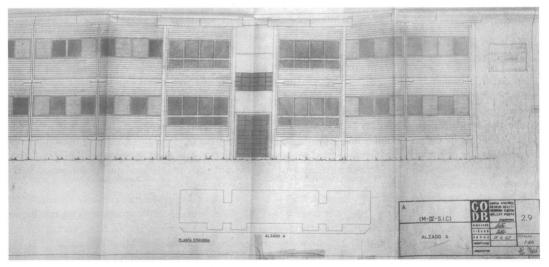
Alzado parcial. Proyecto viviendas en Campanar
